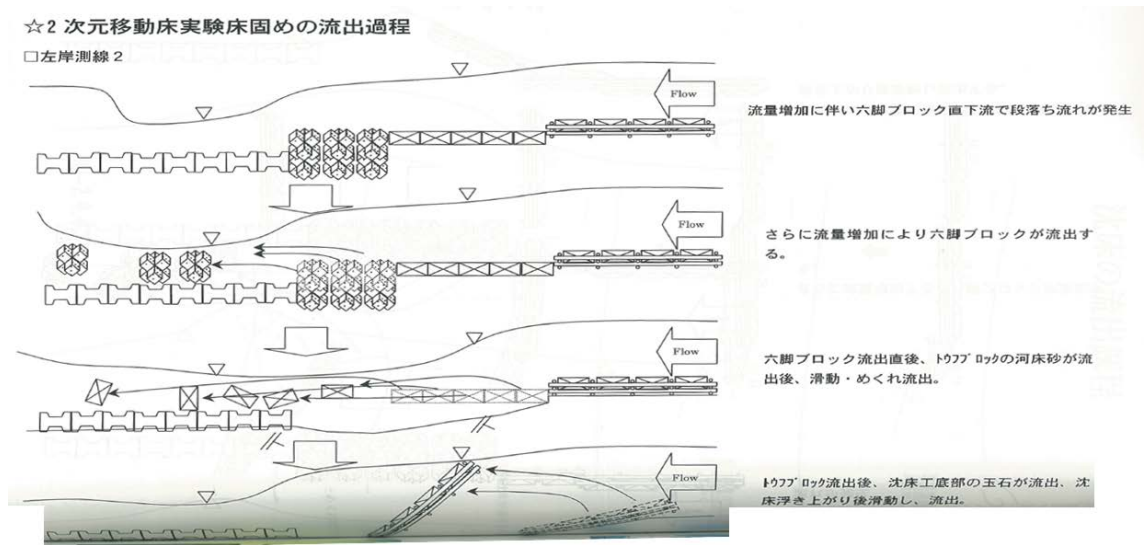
M 床固め工致命的破壊ブロック流失経過
